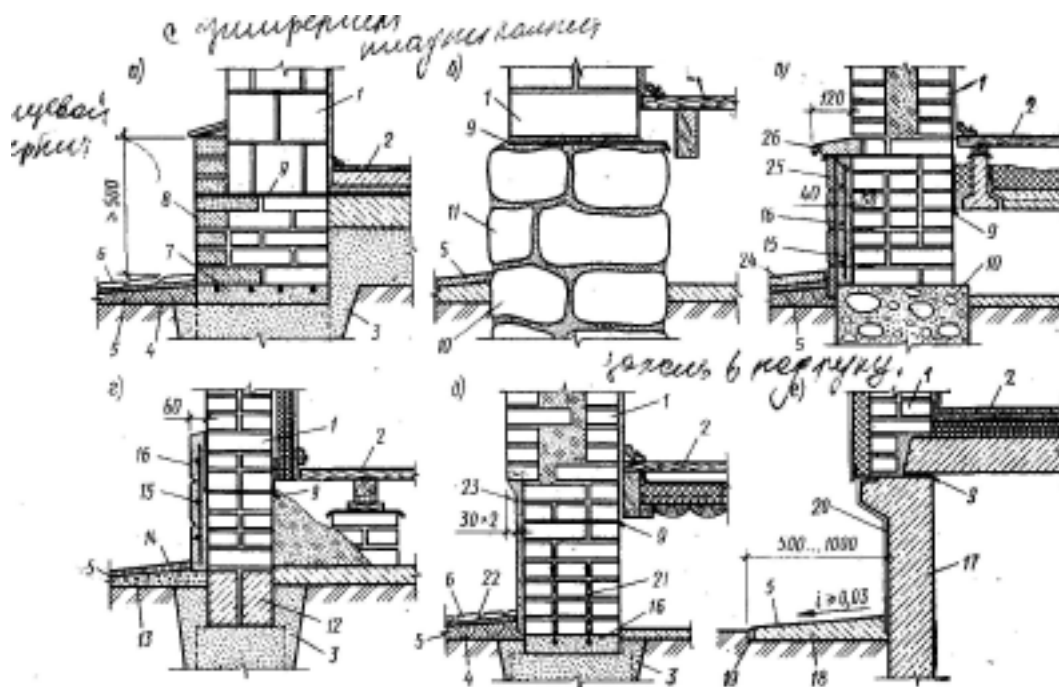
Цоколи каменных стен малоэтажных зданий:
